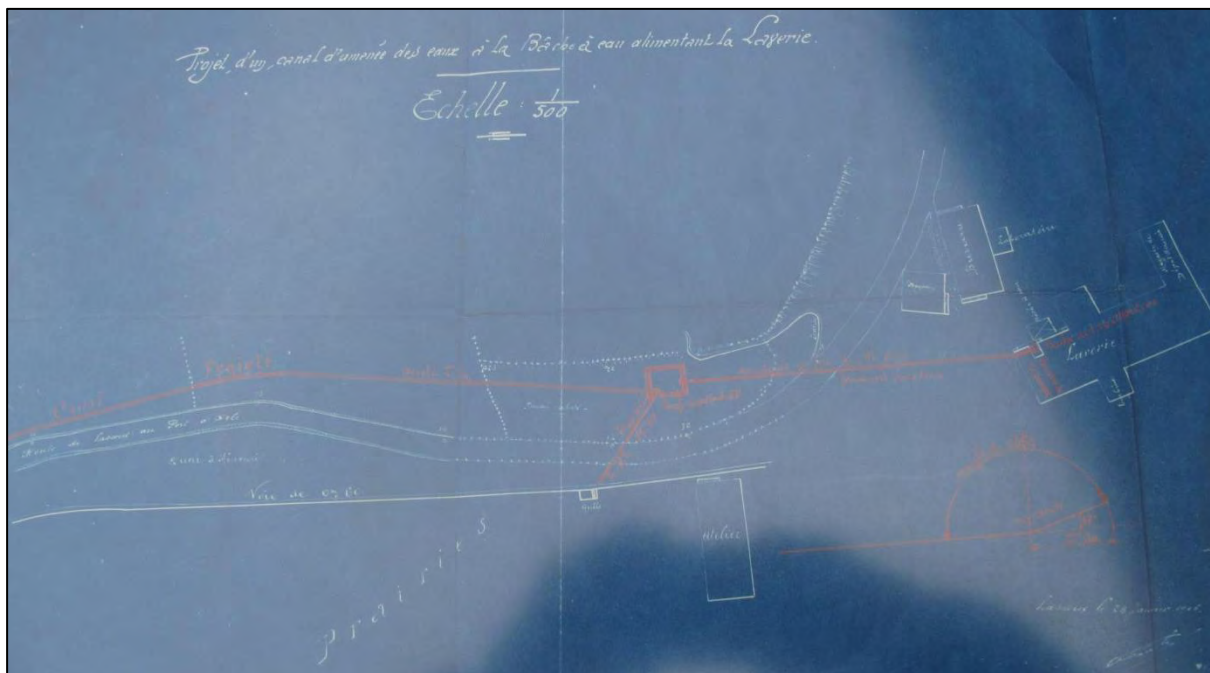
Plan de la laverie de Lascoux et d'installations hydrauliques projetées, daté du 28 janvier 1906
